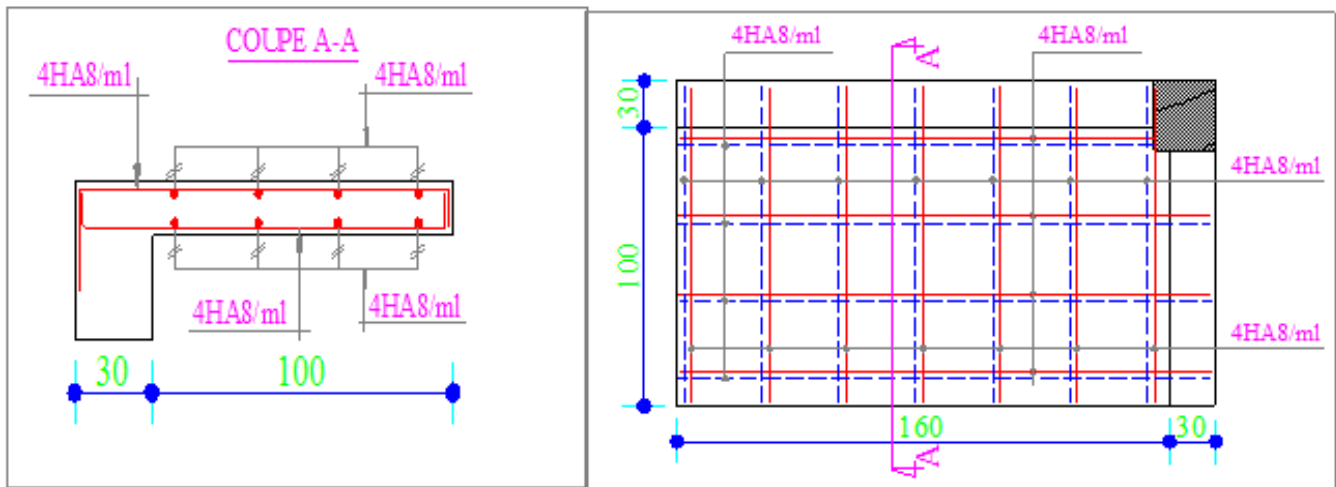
Ferrailage de la dalle sur deux appuis
